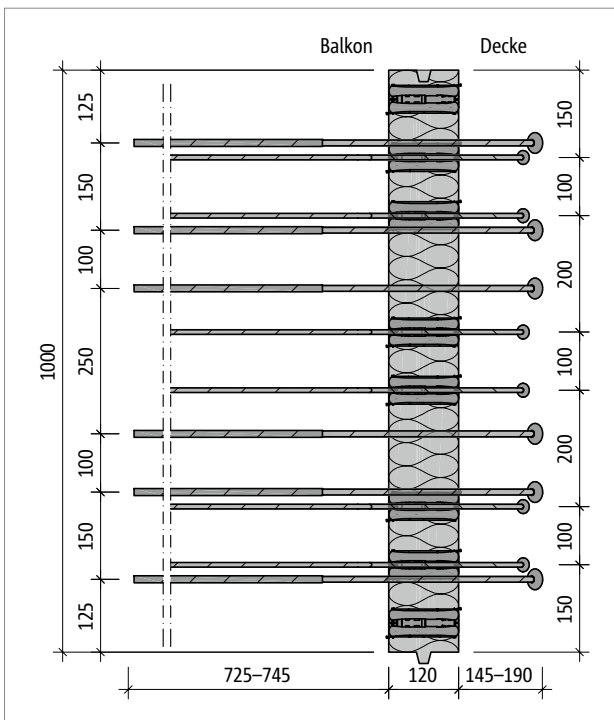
Schöck Isokorb® XT Typ KL-O-M2: Produktgrundriss
